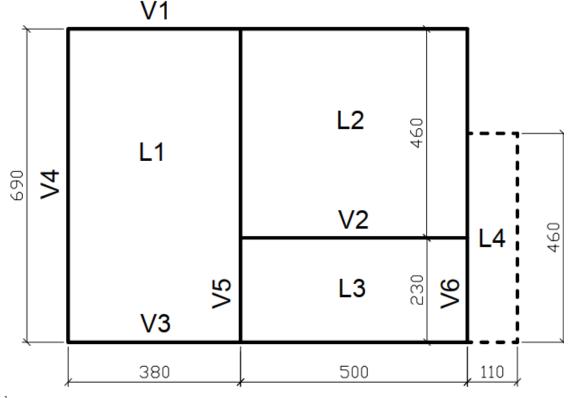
Planta unifilar de lajes com distância até eixo dos apoios [23]¹.
